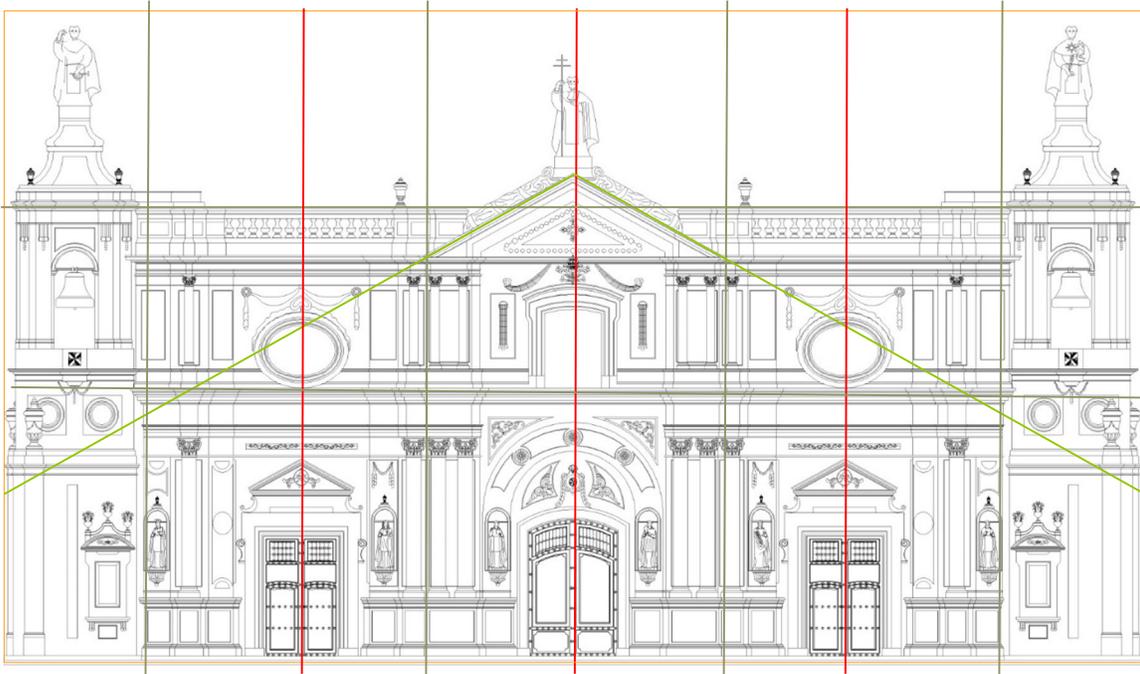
Fachada Santo Domingo. Sin escala. Elaboración propia.
